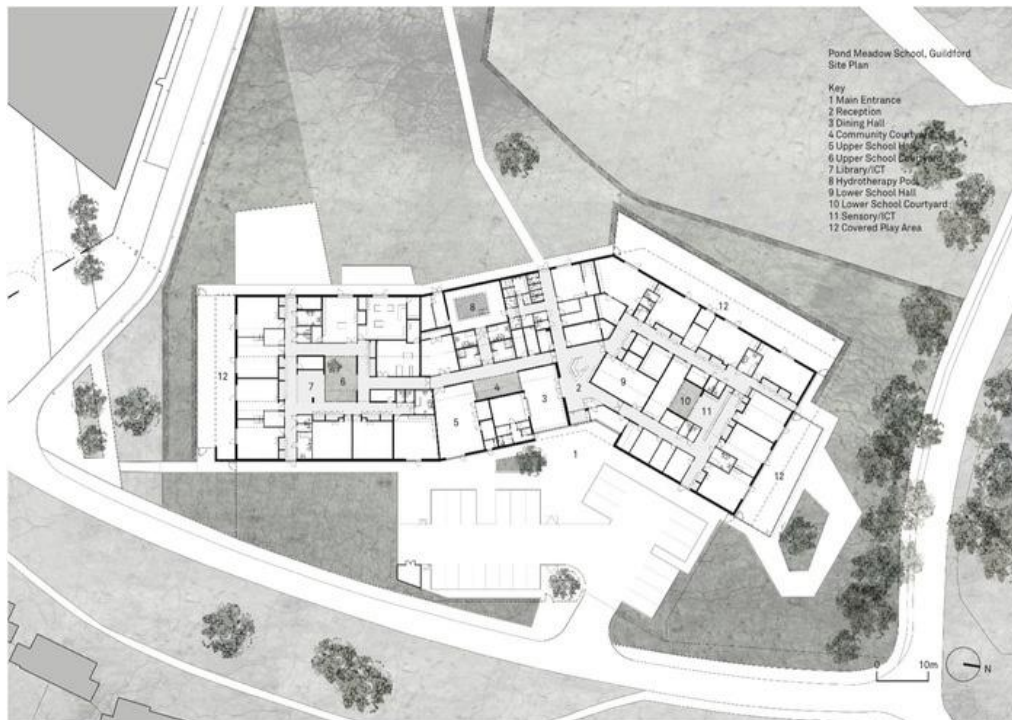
Planta Baixa da Pond Meadow School. / Fonte: DSDHA
